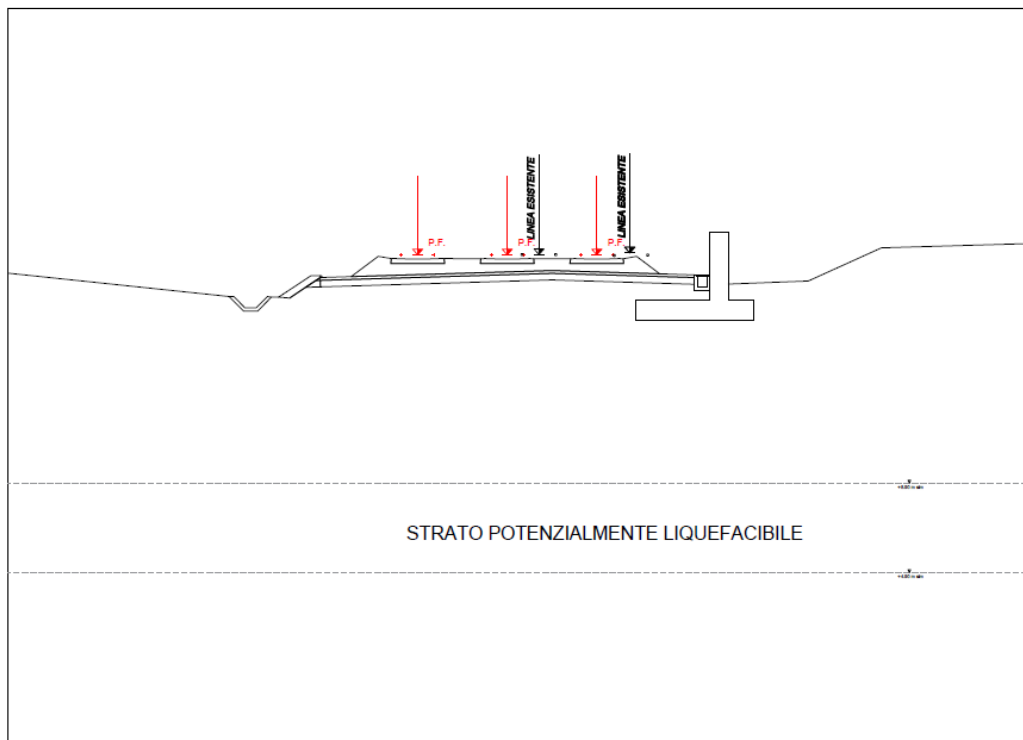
Sezione rilevato alla pk 5+500 su strato di terreno liquefacibile
